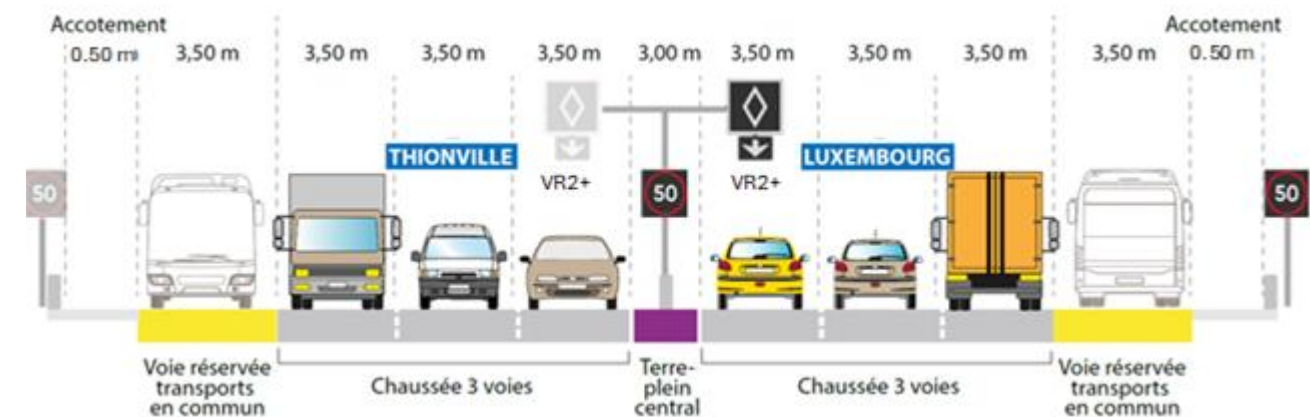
Profil en travers schématique d'une section autoroutière comprenant une voie de covoiturage
